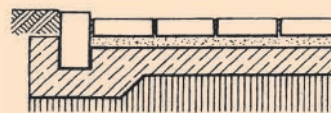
Borde elevado. Unos 2 cm aprox. sobre la superficie del pavimento.
